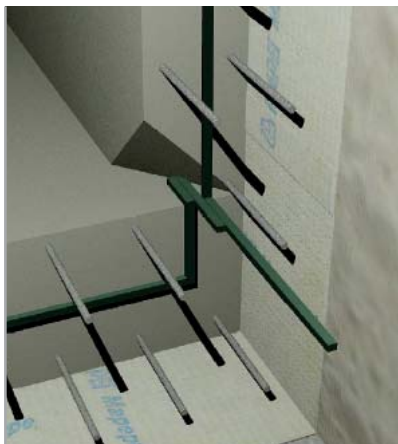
Accostamento tra IDROSTOP B25 utilizzato per sigillare una ripresa di getto in platea con quello impiegato per sigillare le riprese di getto parete-platea e parete-parete
